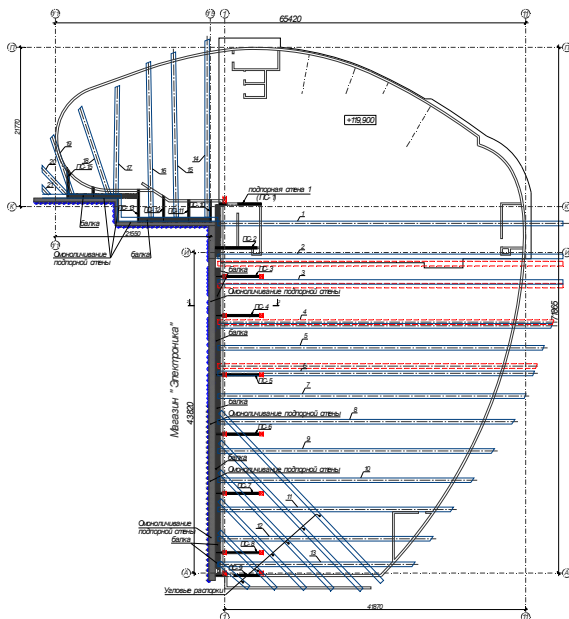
План размещения распорных конструкций для усиления подпорной стены ограждения котлована
